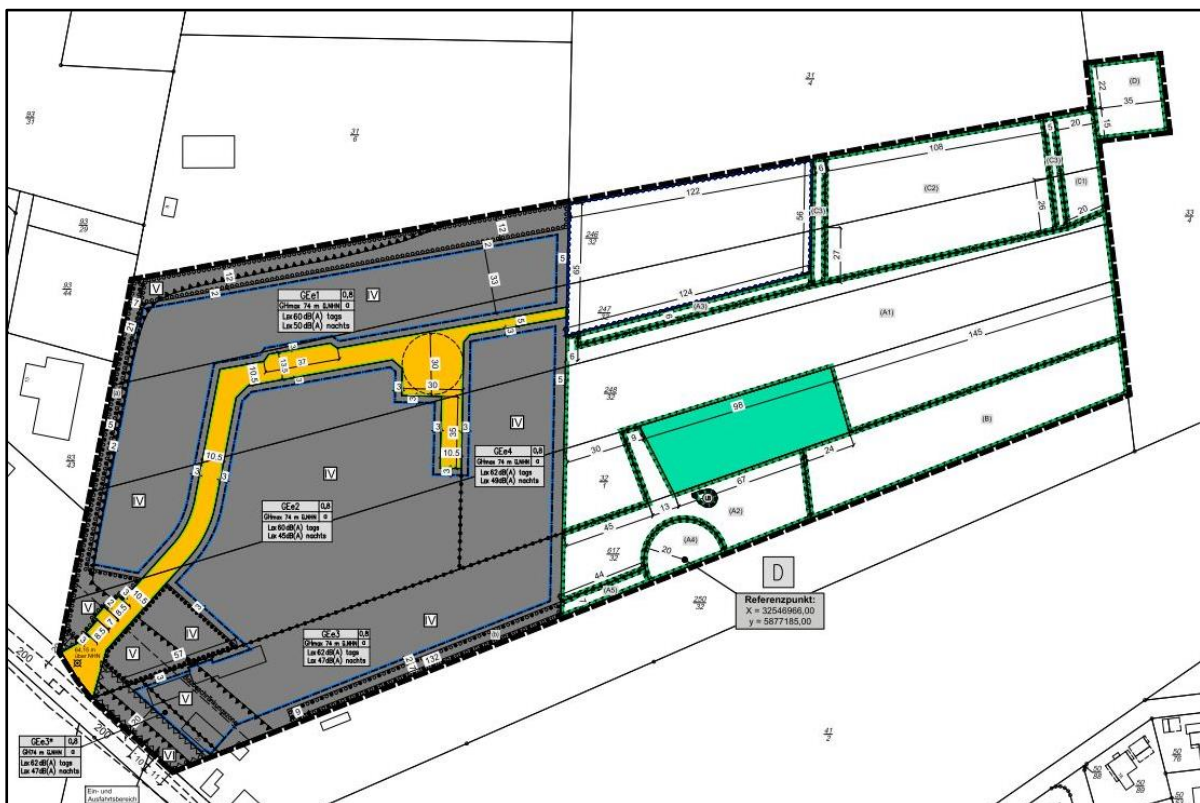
Ausschnitt Planzeichnung BP Nr. 8 „Am Sand Teil II“ (Entwurfsstand: 13.06.2022).
